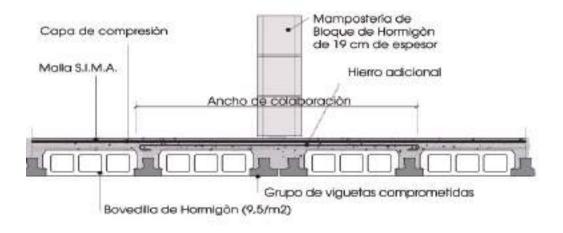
Refuerzos bajo tabique ancho paralelo a viguetas
